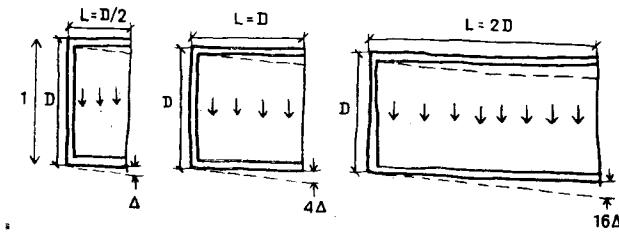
Прогиб при кручении здания с гибкой стеной фасада
